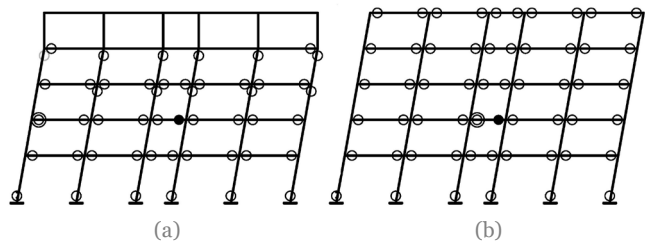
Mecanismos de colapso para pórticos interiores del edificio caso de estudio dimensionado para EC8, con vigas de canto (a) y vigas planas (b).
